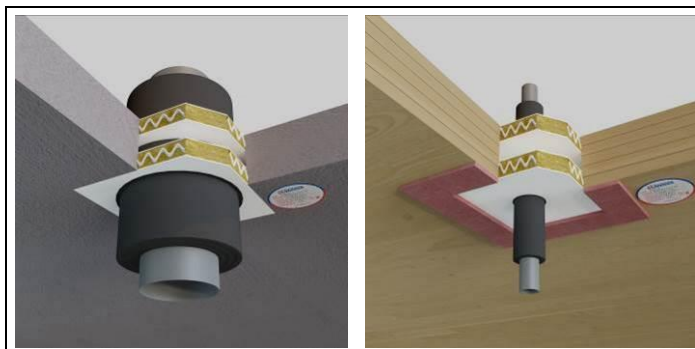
Ejemplo de sellado de tuberías metálicas aisladas en suelos.
